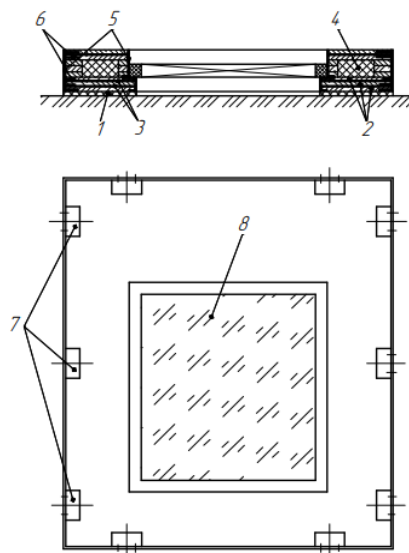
Конструкція будівельної панелі у металевому каркасі та з вбудованим вікном:
